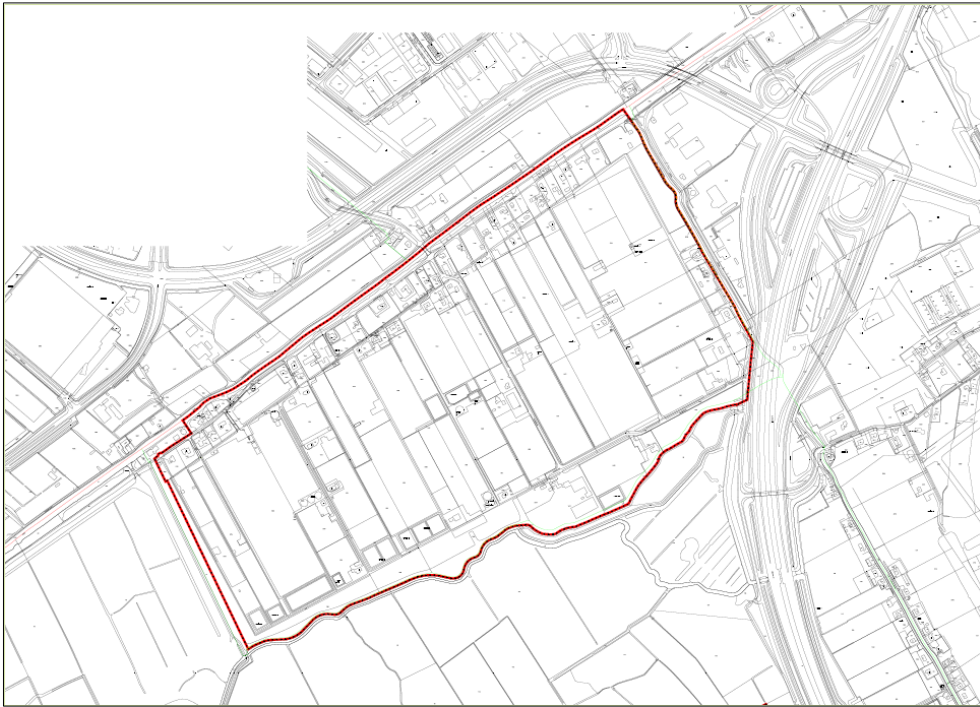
voorontwerp bestemmingsplan plangrens de Oude Campspolder
